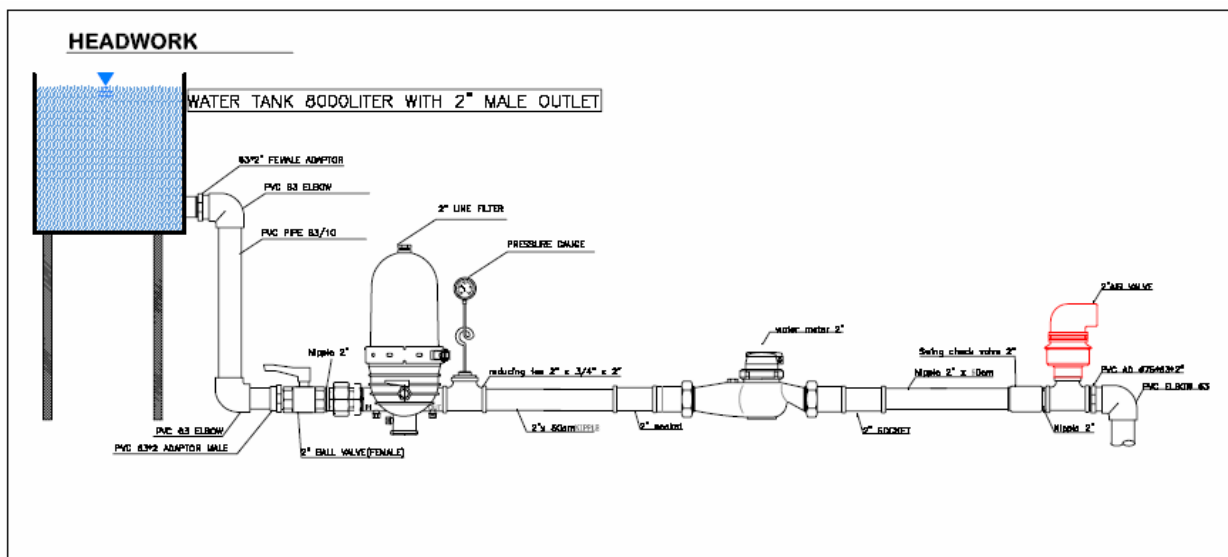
Schema costruttivo dell'impianto di testa dell'impianto di irrigazione a goccia, aprile 2006
